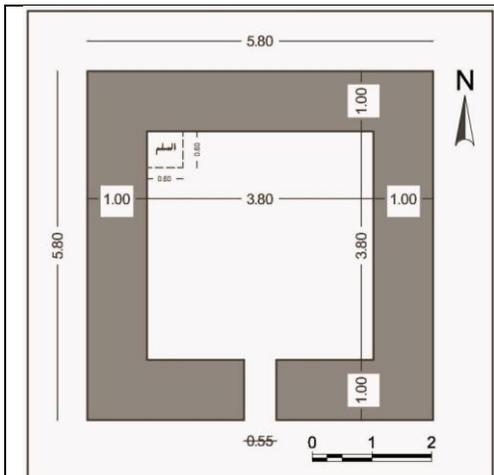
أطم (حصن) بن عميره: مسقط أفقي للطابق الثاني.
